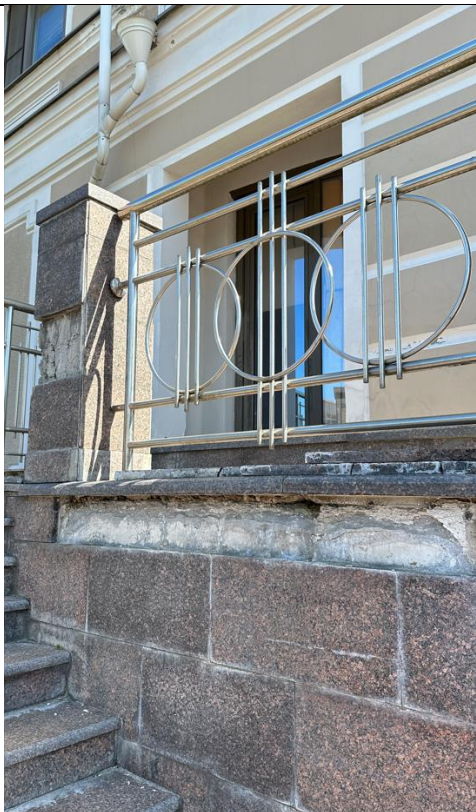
Общий вид условной части №4 южной стороны фасада здания и дефекты в виде растрескивания штукатурки и окраски на фасаде, откосах и балконах
